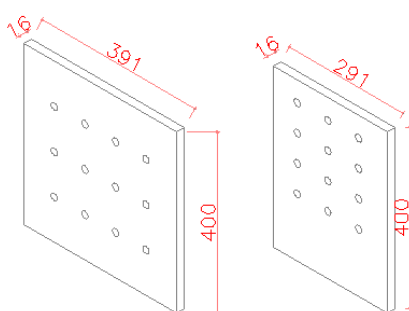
Chapas de ligação do pilar metálico ao concreto.
